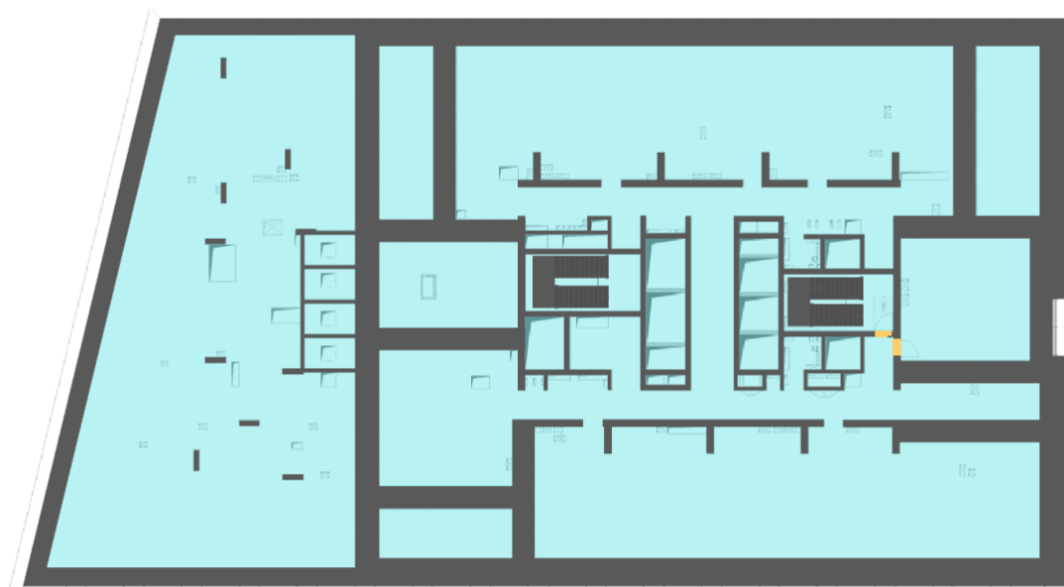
План техпространства на отм. +30.900 и нанесенная на него расчетная (принципиальная) схема эвакуации
